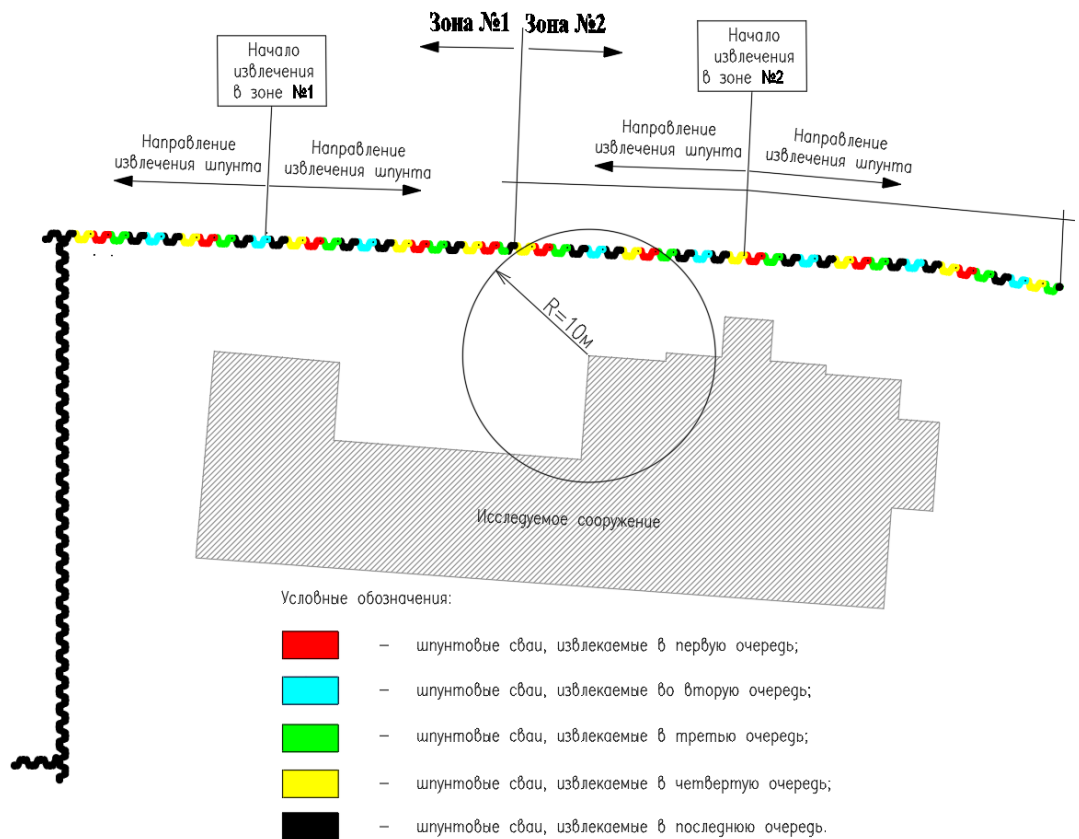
План опытной площадки и принципиальная схема извлечения свай
